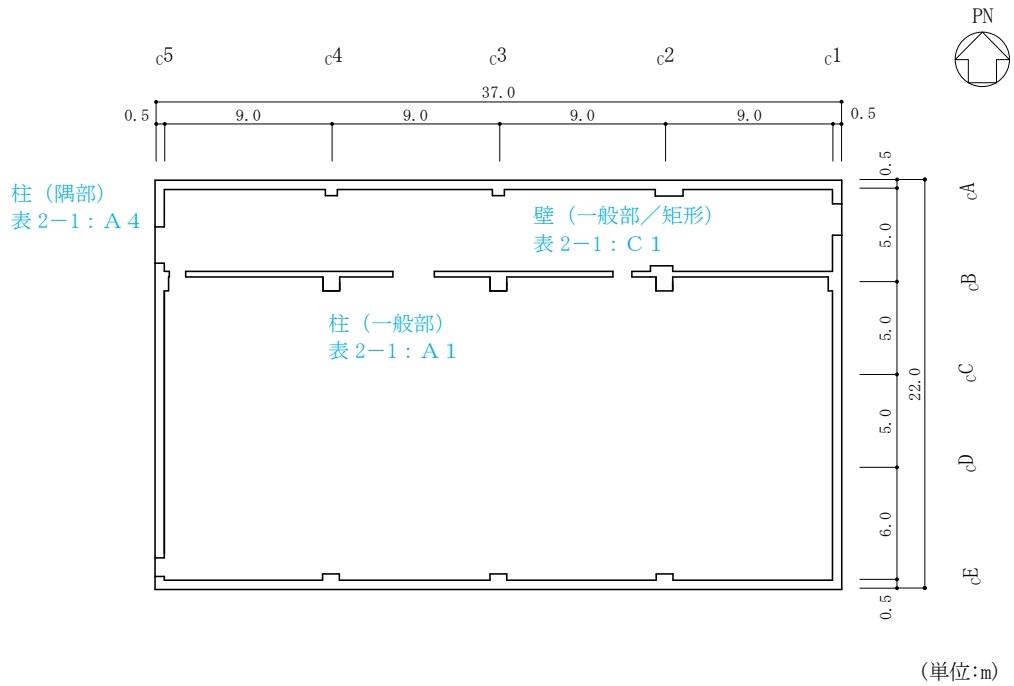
(4) 制御室建物の概略平面図 (EL 16.9m)
